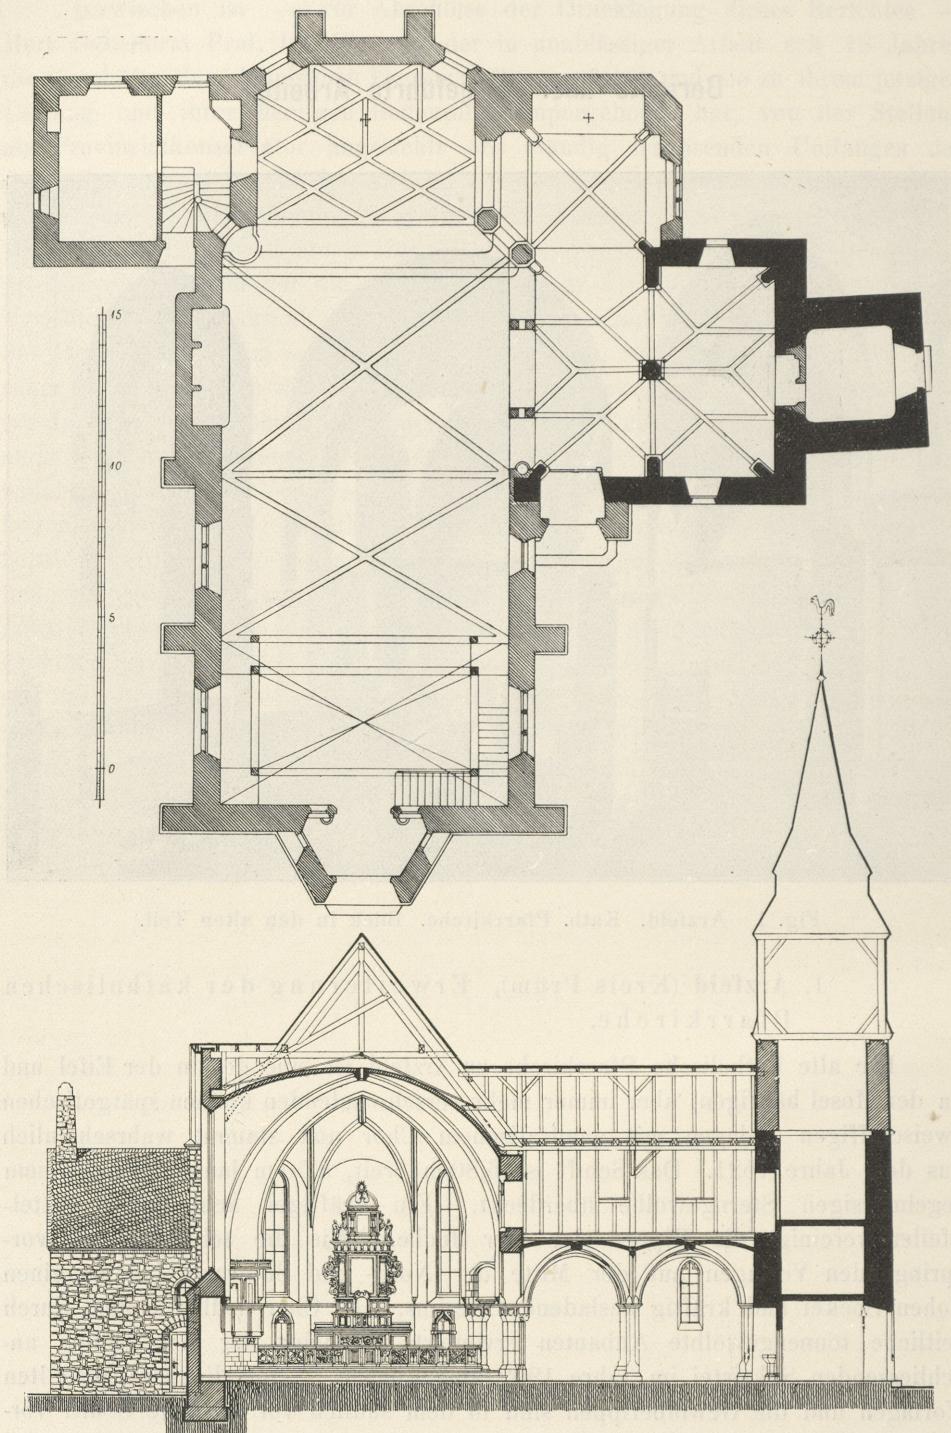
Arzfeld. Kath. Pfarrkirche. Grundriss und Querschnitt.
